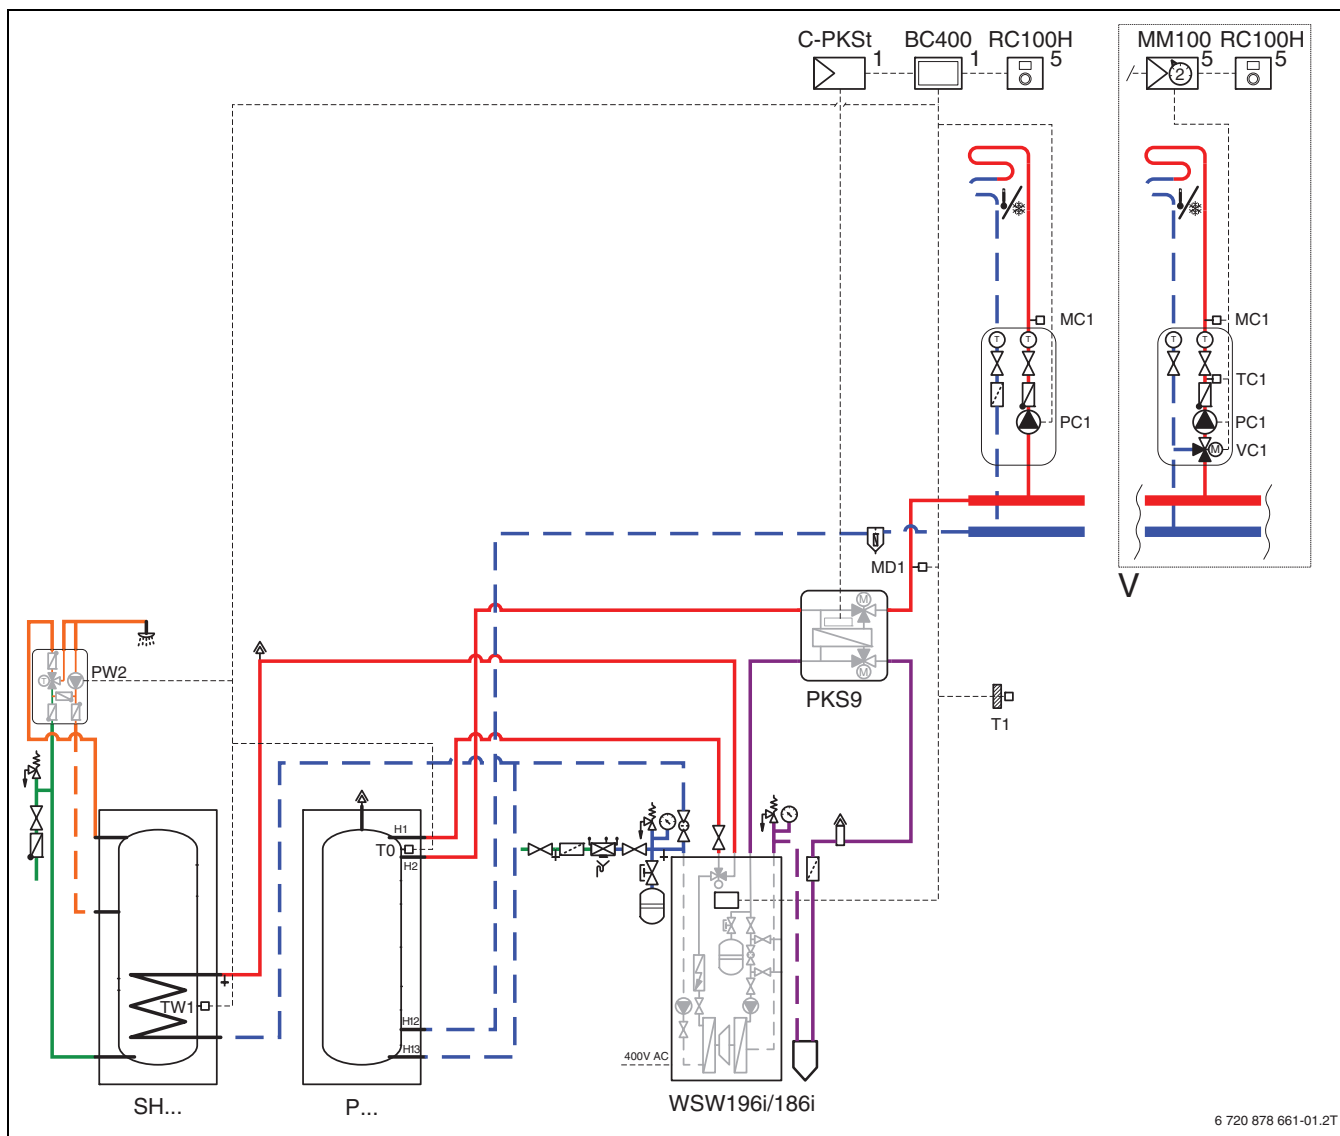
Akumulačné zásobníky s pasívnou chladiacou stanicou (PKS)
